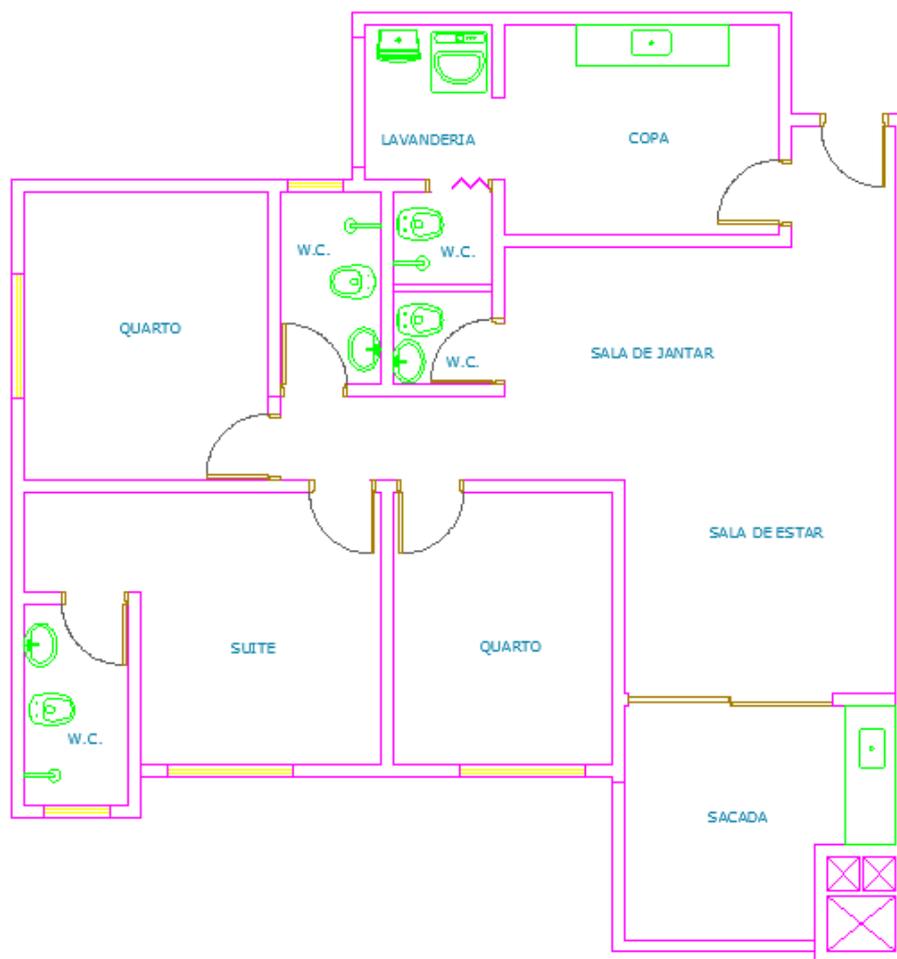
Planta baixa Apartamento Tipo do Condomínio Parque Residencial Pantanal
